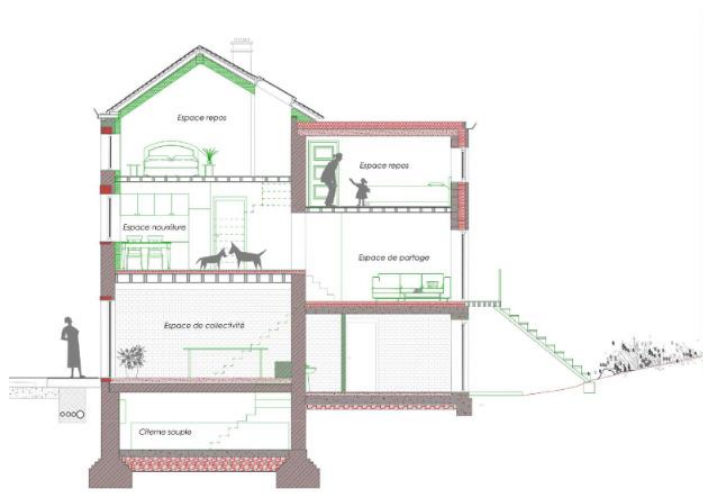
Test en plans et coupe de l'aménagement d'une maison mitoyenne avec un logement aux étages et un espace pour la communauté de Pepinster au rez-de-chaussée – Groupe B, 2022
